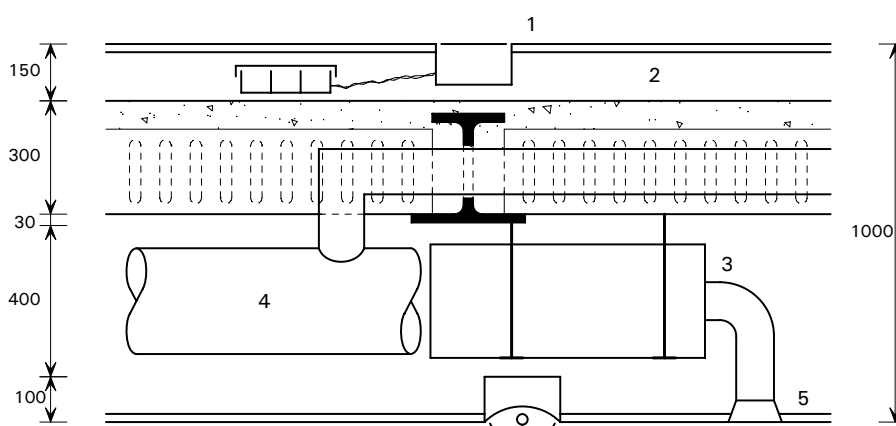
Možnosti umístění technického zařízení nad nebo pod stropní konstrukcí [3]
